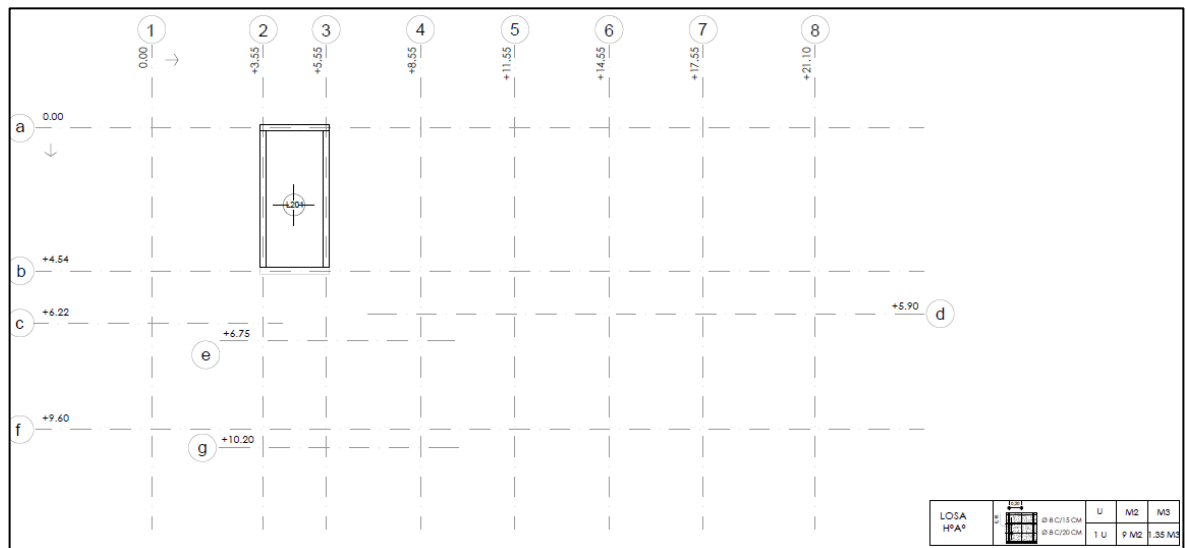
Esquema de estructura – Losas sobre 1º Piso
